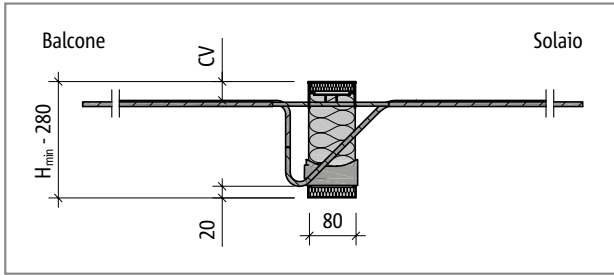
Schöck Isokorb® tipo K10S - K60S, sezione del prodotto
